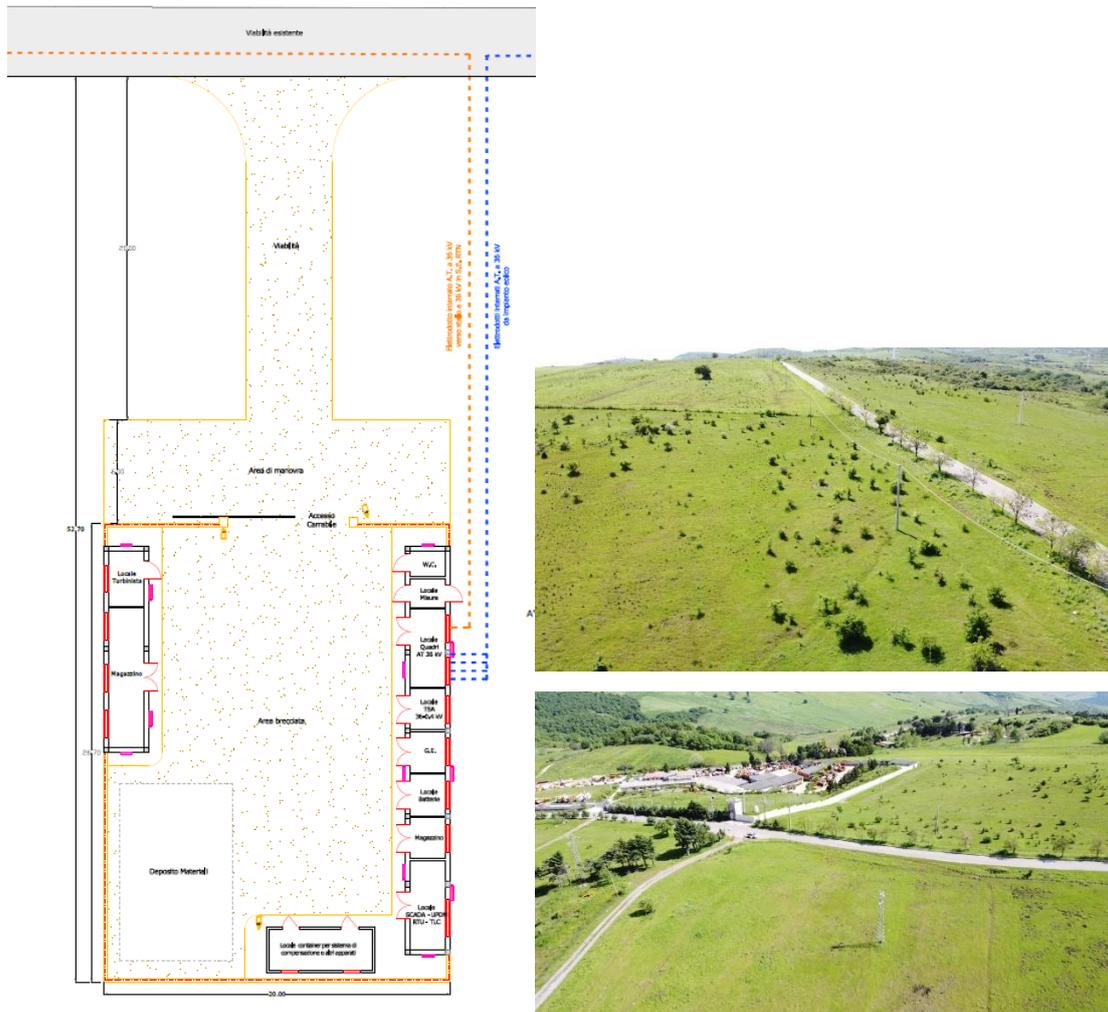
Planimetrie della CEU e viste aeree dell’area di realizzazione
